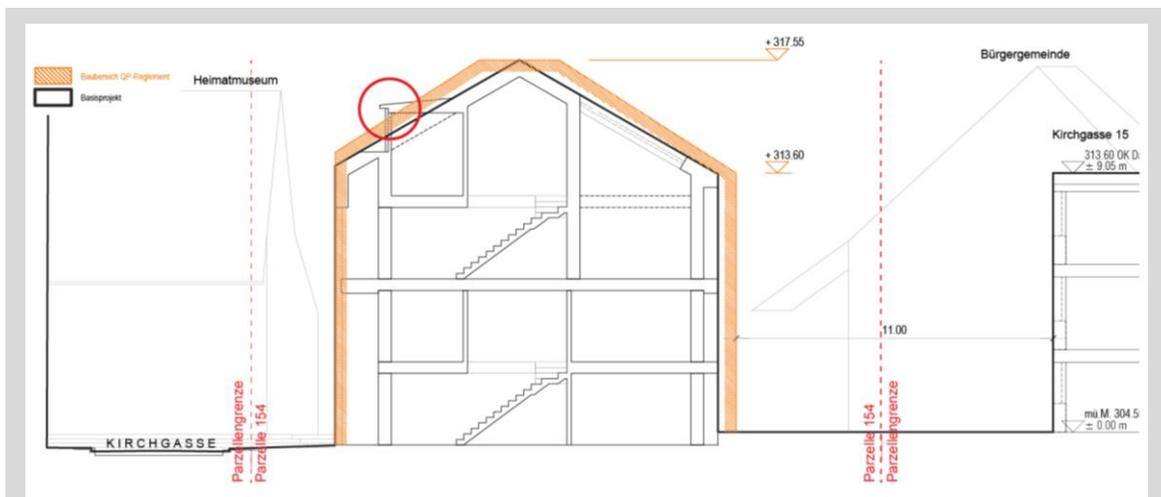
Schemaschnitt Baubereich B mit Dachaufbaute (Quelle: Burckhardt + Partner AG)
